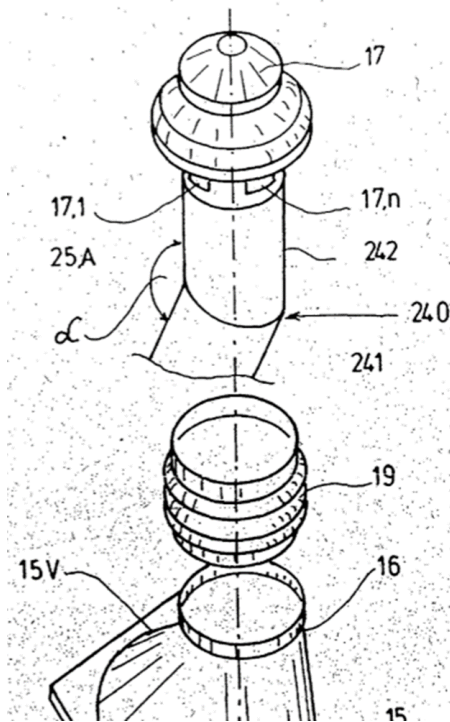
Фрагмент вытяжной кровельной вентиляции с колпачком головки вентиляционной трубы
